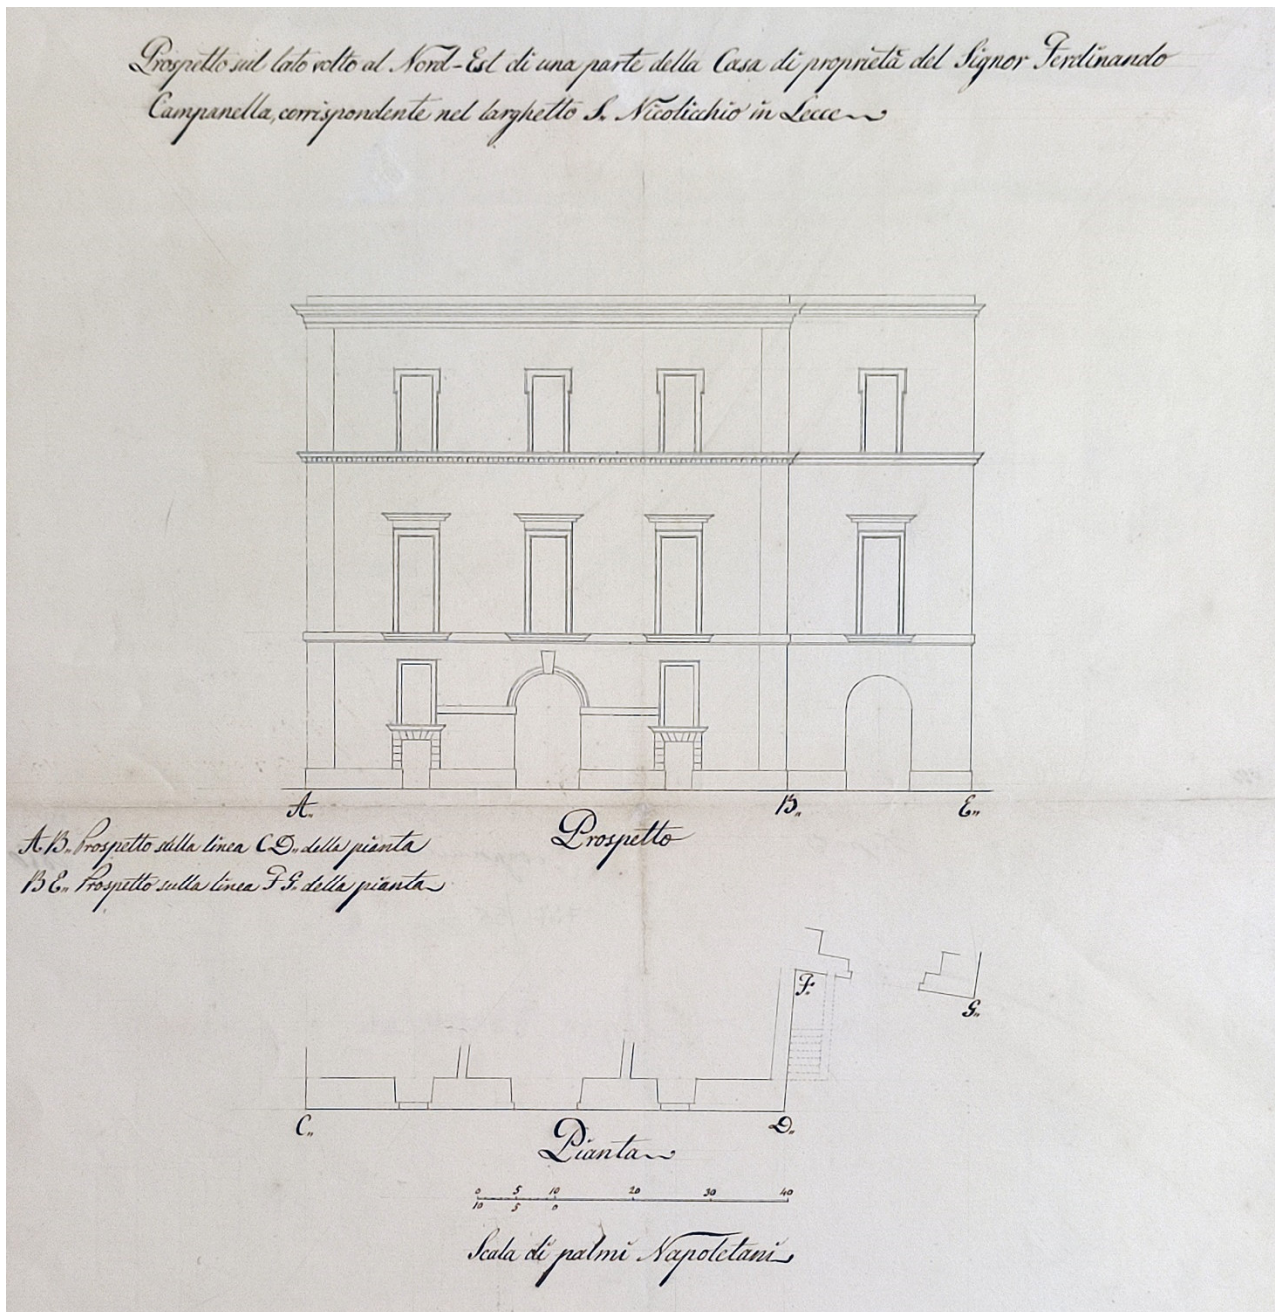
Prospetto sul lato Nord-Est di una parte della Casa del Signor Campanella e porzione di pianta 1850 (ASL, Int. Aff. Part.ri)
